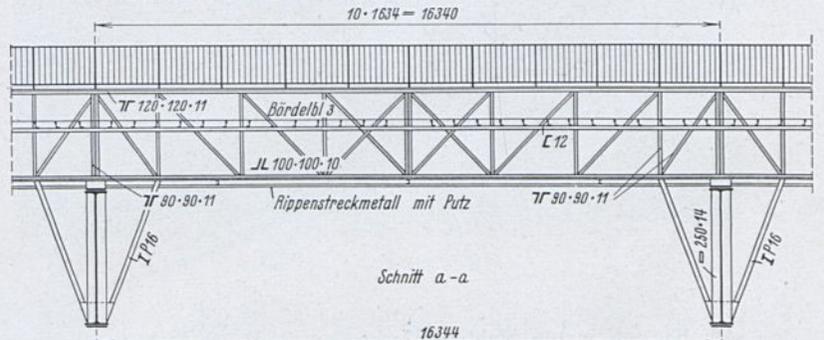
Mittelfeld einer Fachwerkpfette des Kragarmes mit den Kopfbändern für die Haltung der gedrückten Bindergurtung.
